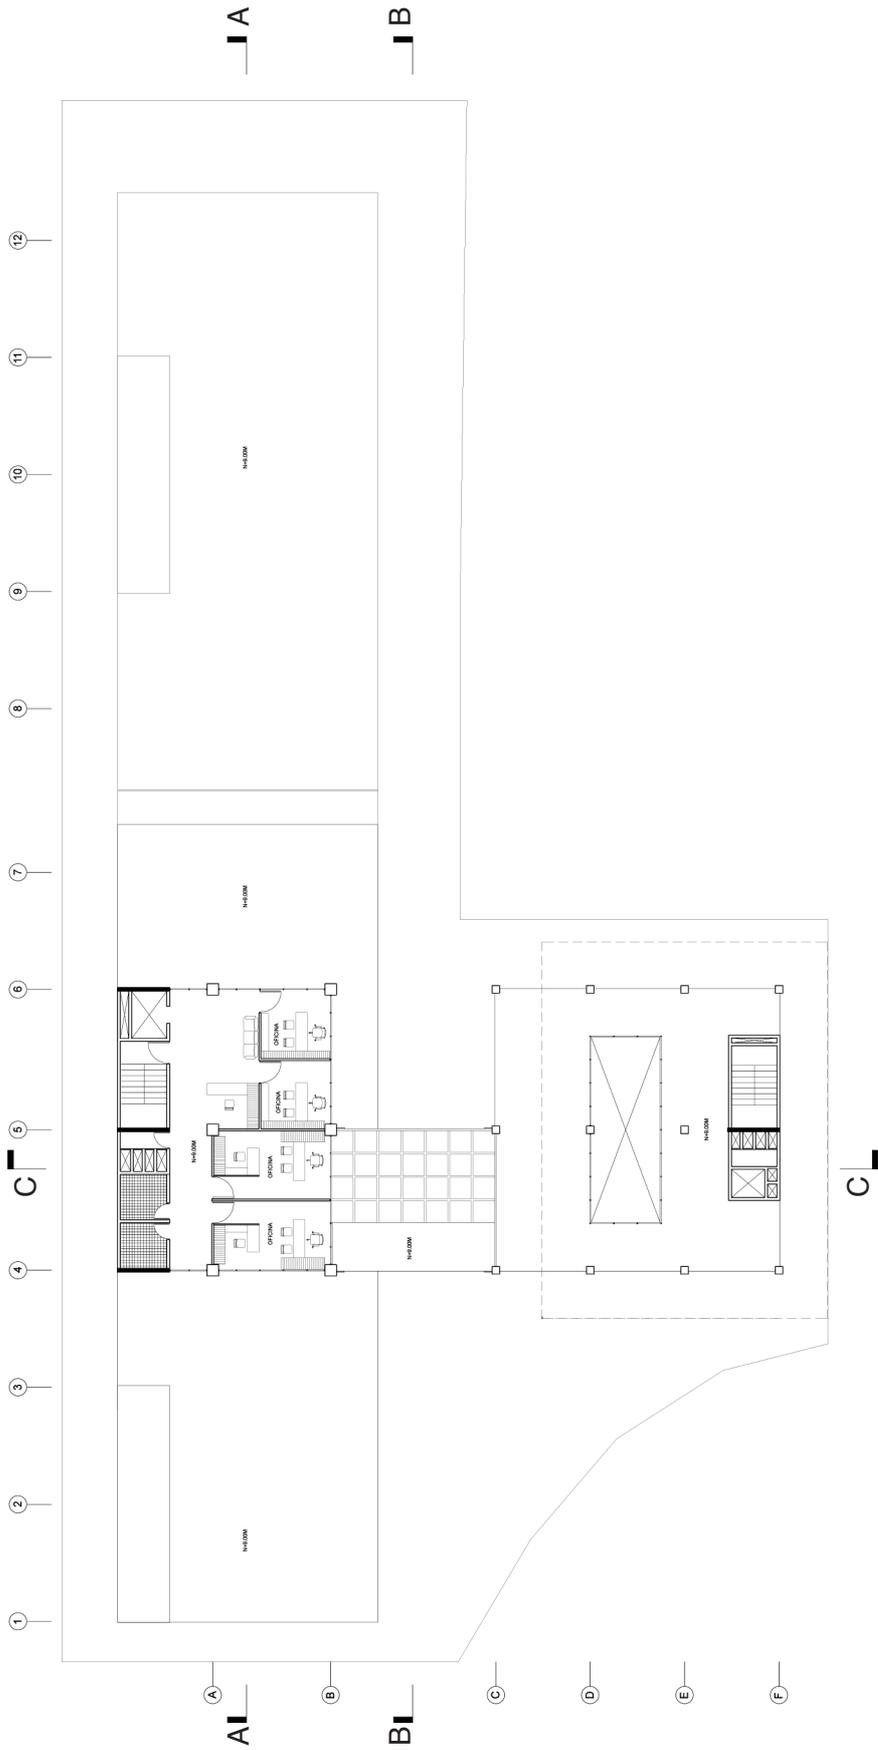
Planta Baja ESC. 1:400 (Elaboración Propia)
